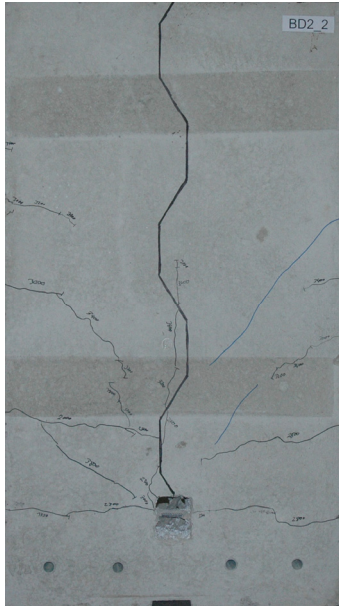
Typisches Rissbild der BD2-Serie    Abb. 4.25: Betonausbruch auf der Innenseite (weit im Nachbruchbereich)
